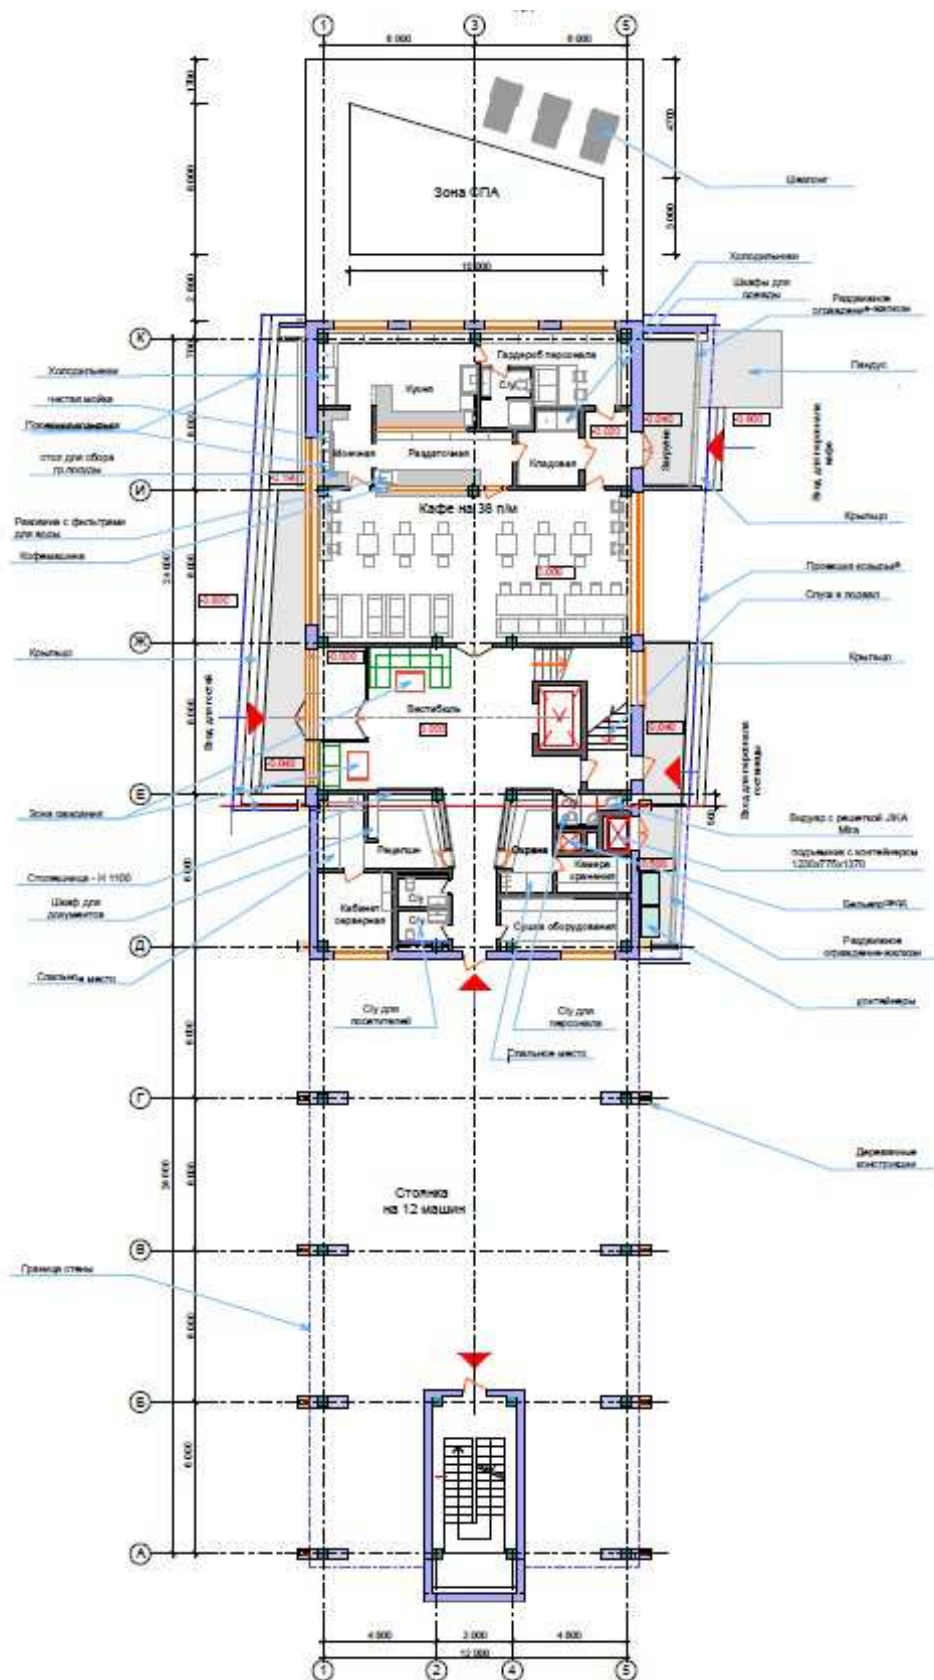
План 1-го этажа (на отм. 0,000)
